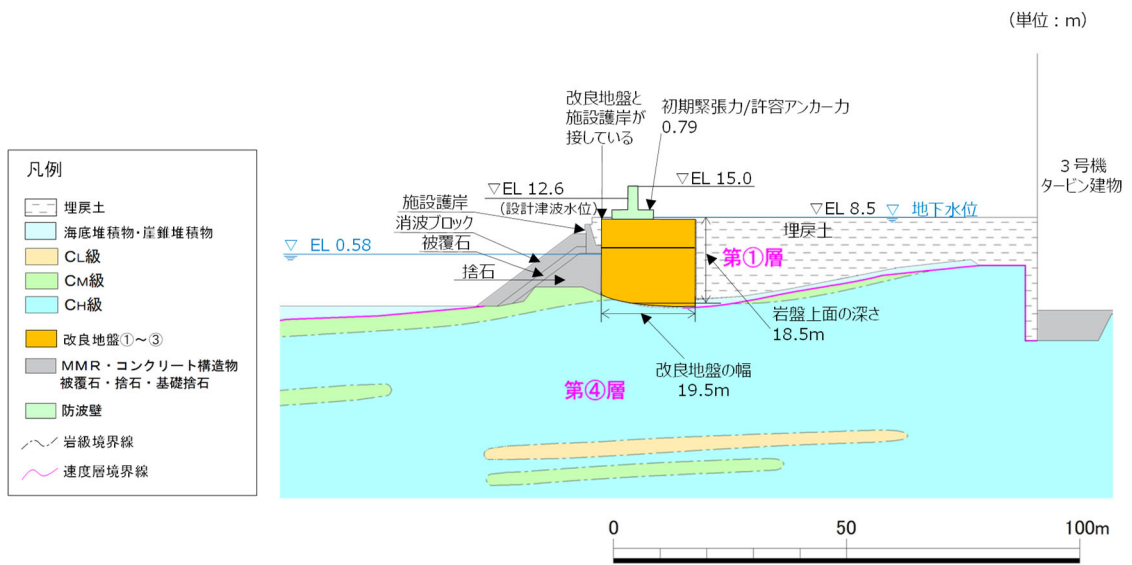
防波壁（逆 T 擁壁）の横断面図（⑤-⑤断面）
